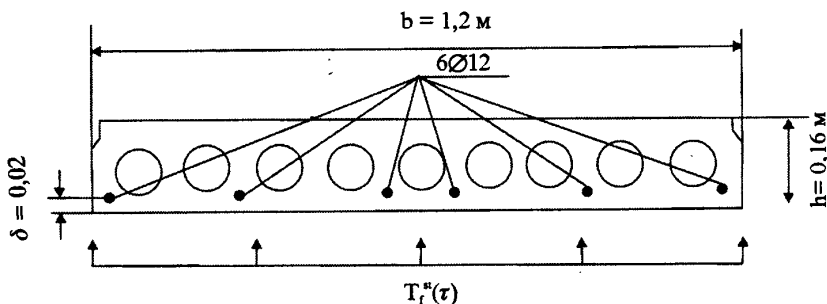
Поперечное сечение заданной многопустотной железобетонной плиты перекрытия и принятая схема воздействия пожара на плиту
